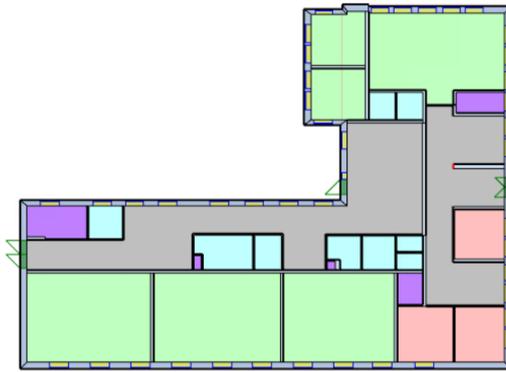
Grundriss Erdgeschoss, zoniert
